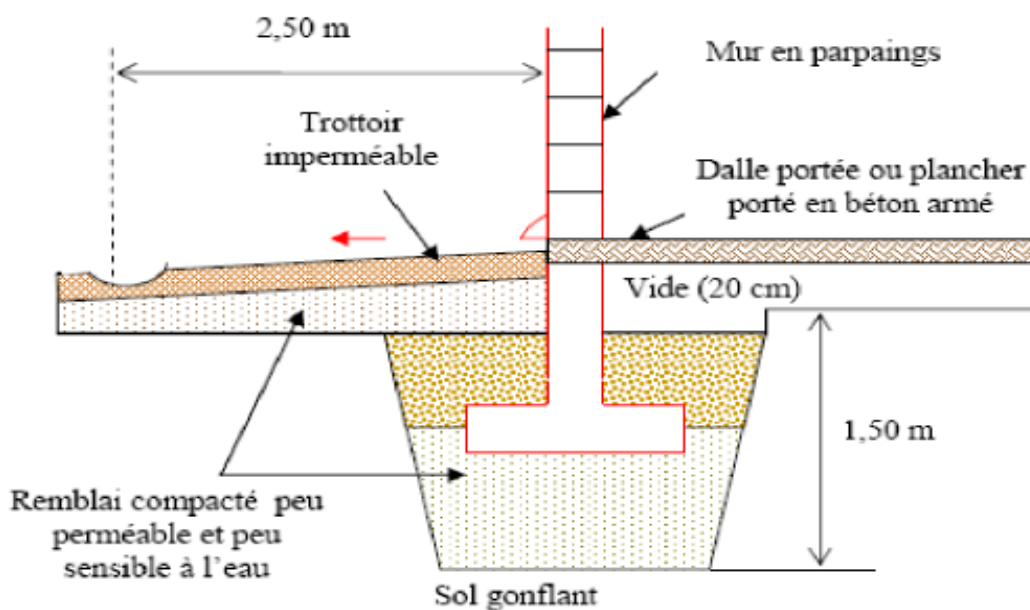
Semelles superficielles sur remblai partiel + vide sanitaire (Ferrah, 2006).
